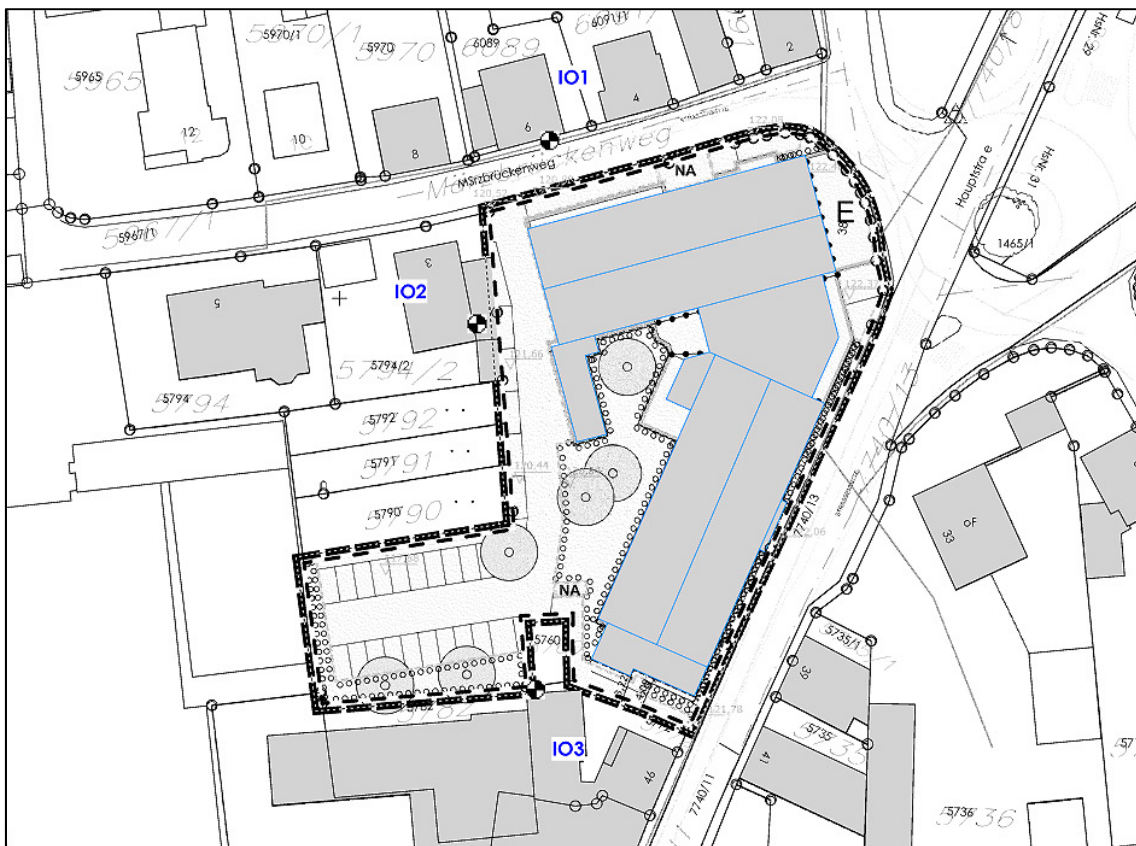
Lageplan mit Darstellung der maßgeblichen Immissionsorte
